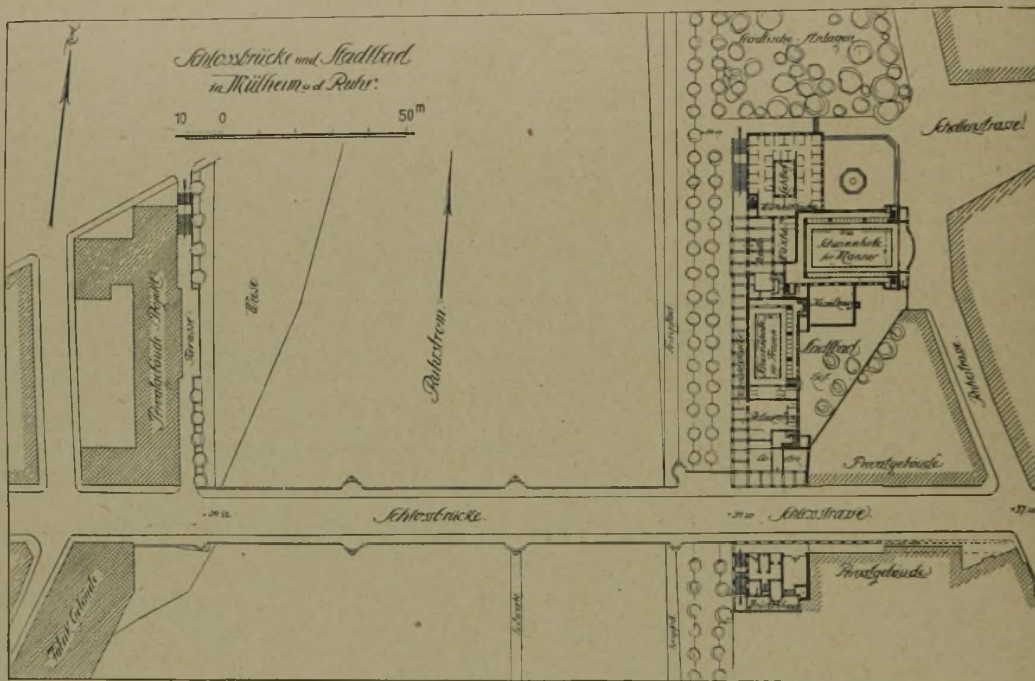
Lageplan mit Erdgeschoß-Grundriß für Stadtbad und Brückenhäuserhaus.
